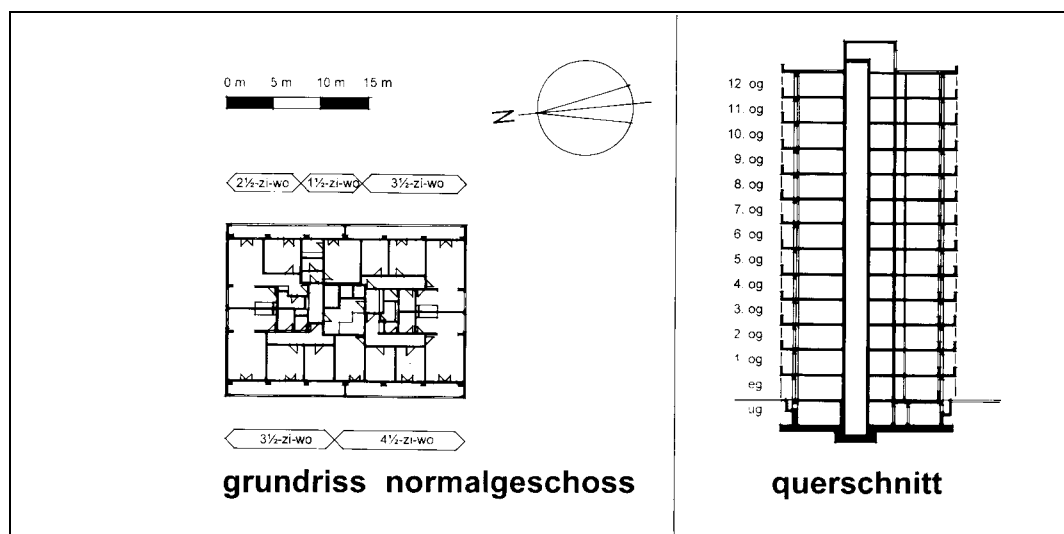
Grundriss Normalgeschoss und Querschnitt von Objekt 4.
